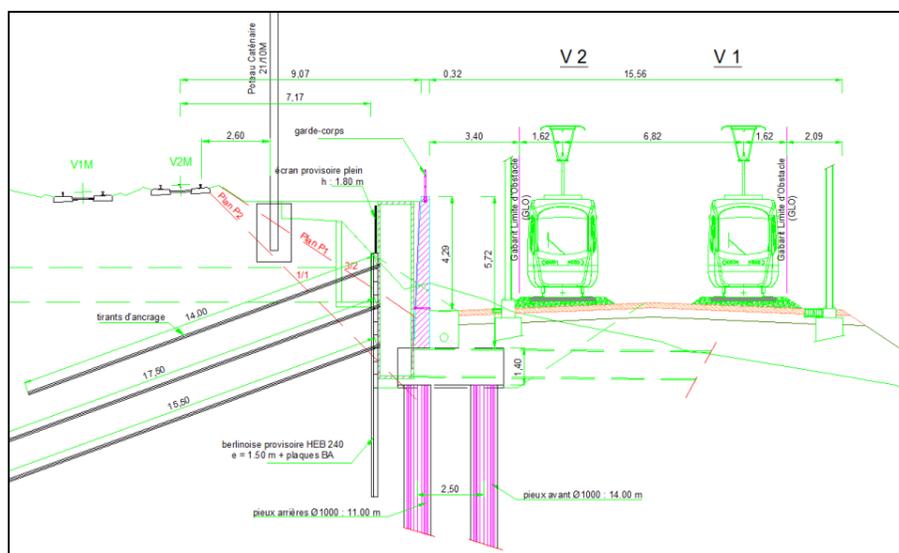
Coupe de principe du mur de soutènement de la virgule de Saint-Cyr-l'Ecole en section courante
